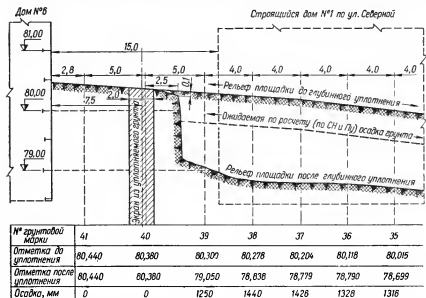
Грунтовой перепад в южной части уплотняемого участка со стороны торца жилого дома № 6, защищенного водозащитным экраном из уплотненного грунта.
